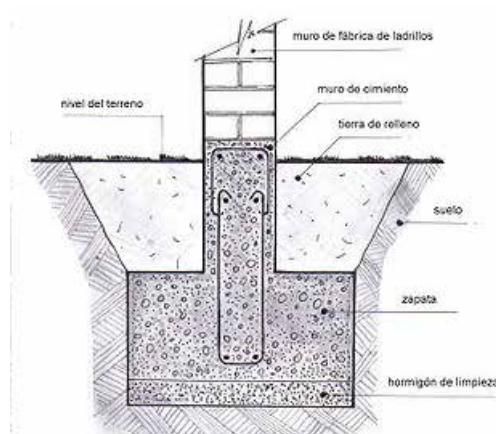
Detalle de zapata rígida Fuente: http://www.construmatica.com/construpedia/Cimentaciones_por_Zapatas (2016)
